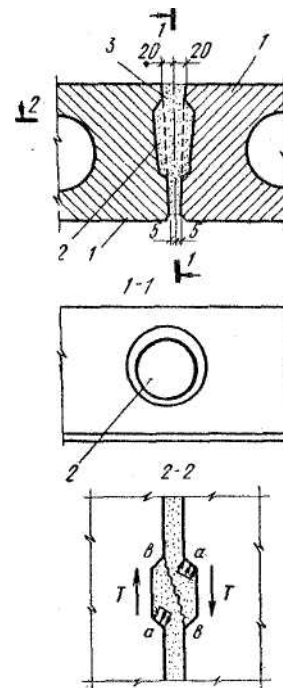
Шпоночное сопряжение сборных панелей перекрытий: 1 – ригель; 2 – плита 3 – отгиб;
